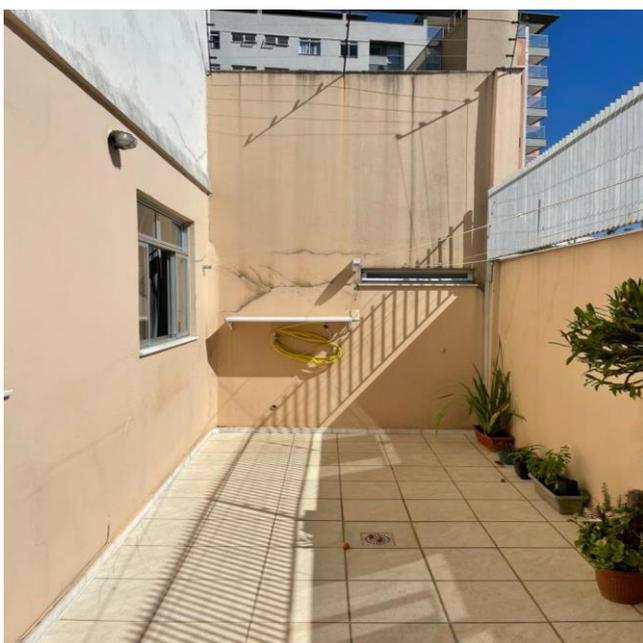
Apartamento 102 e do bloco A – trincas no fundo desta parede.
